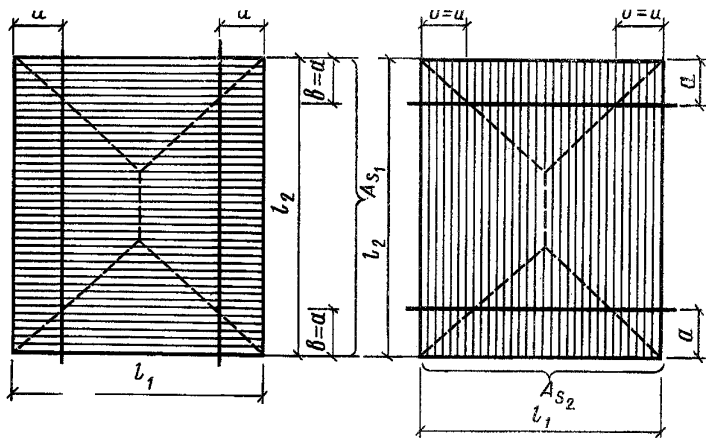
Места обрыва продольных и поперечных стержней в прямоугольной плите
